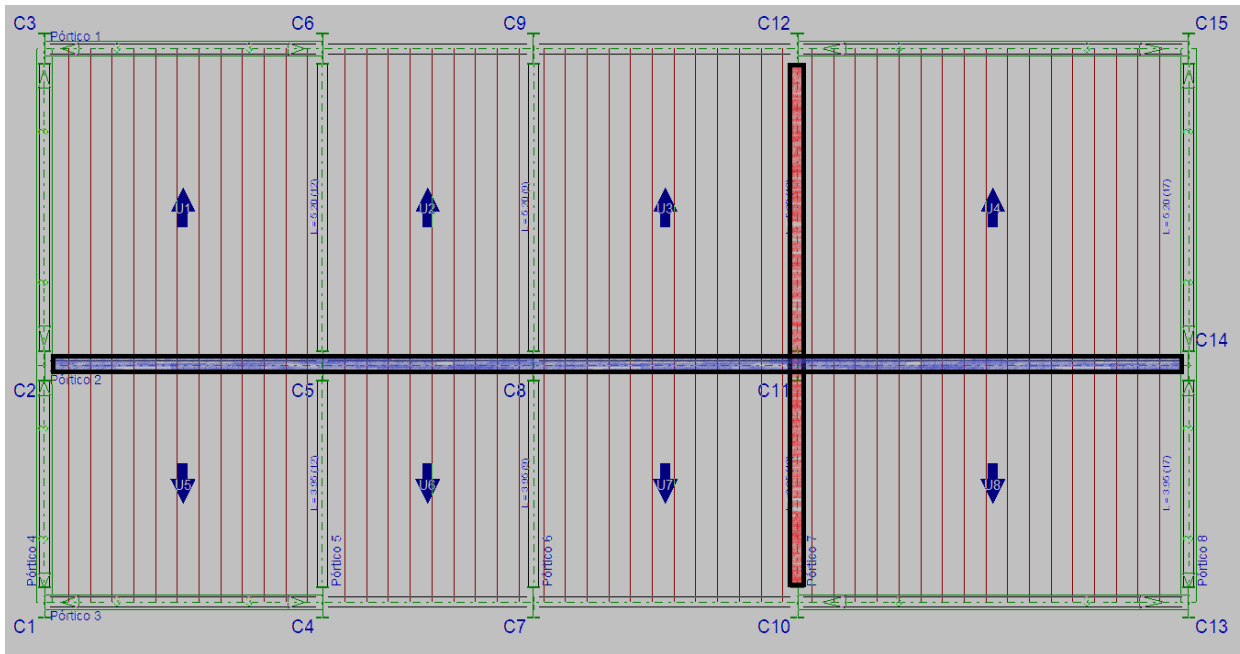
Vigas más cargadas en el forjado 4 (Cubierta)
